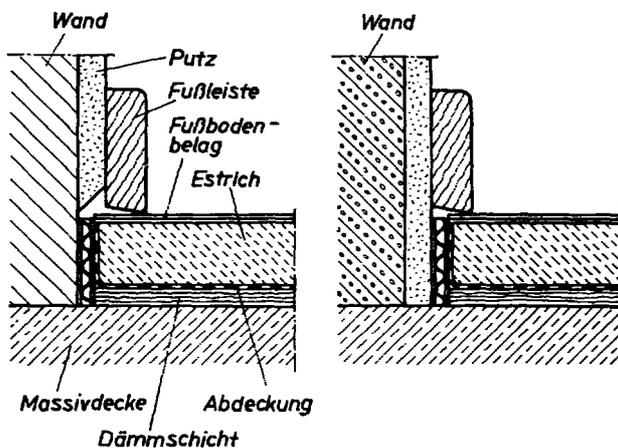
Wandanschlüsse bei schwimmenden Estrichen
